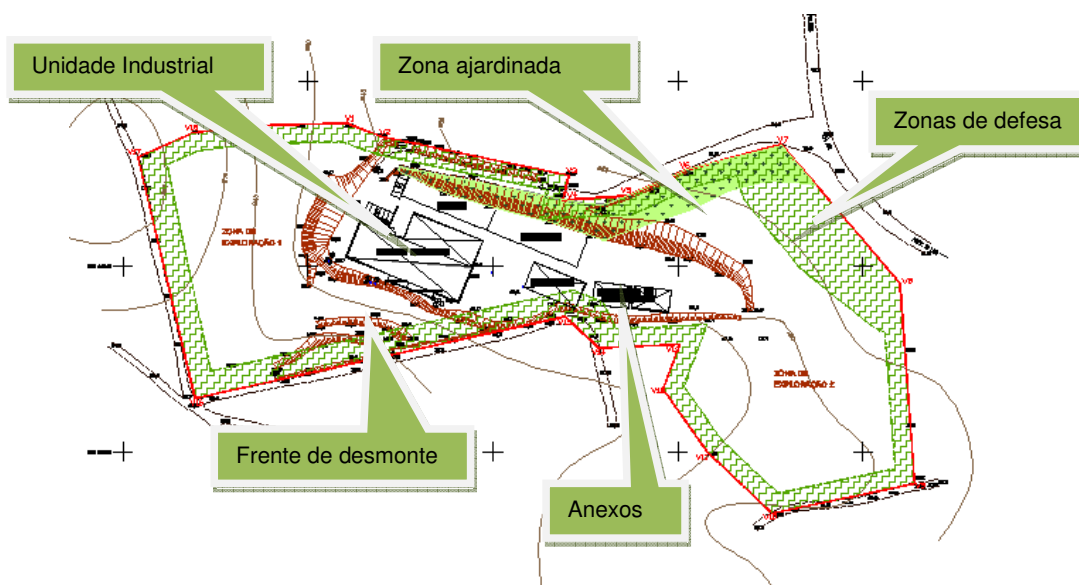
Levantamento topográfico da área do projecto.
